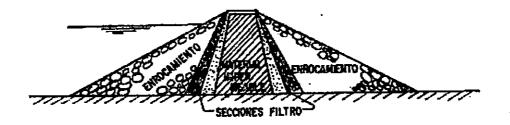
Sección típica de enrocamiento y corazón impermeable.
